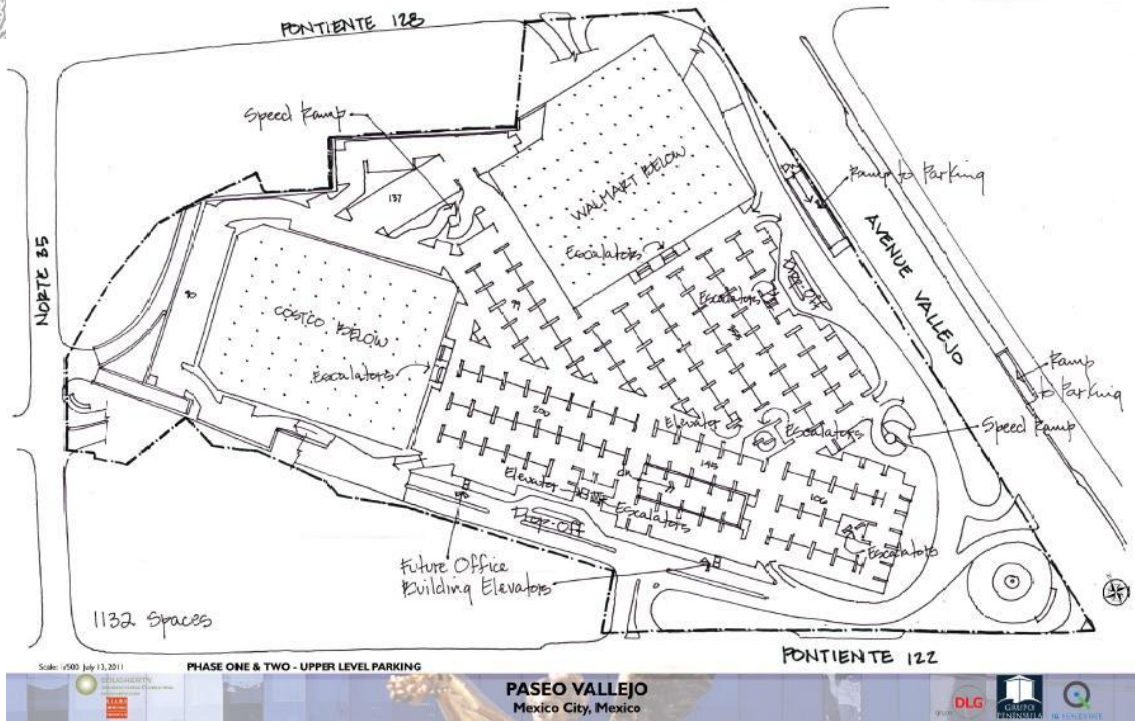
SEMBRADO DE LAS ESTRUCTURAS DE INTERES
